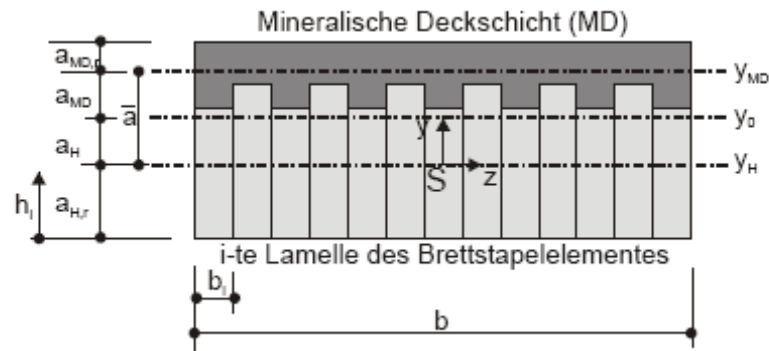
Bezeichnungen am Verbundelement mit alternierenden Lamellenhöhen
